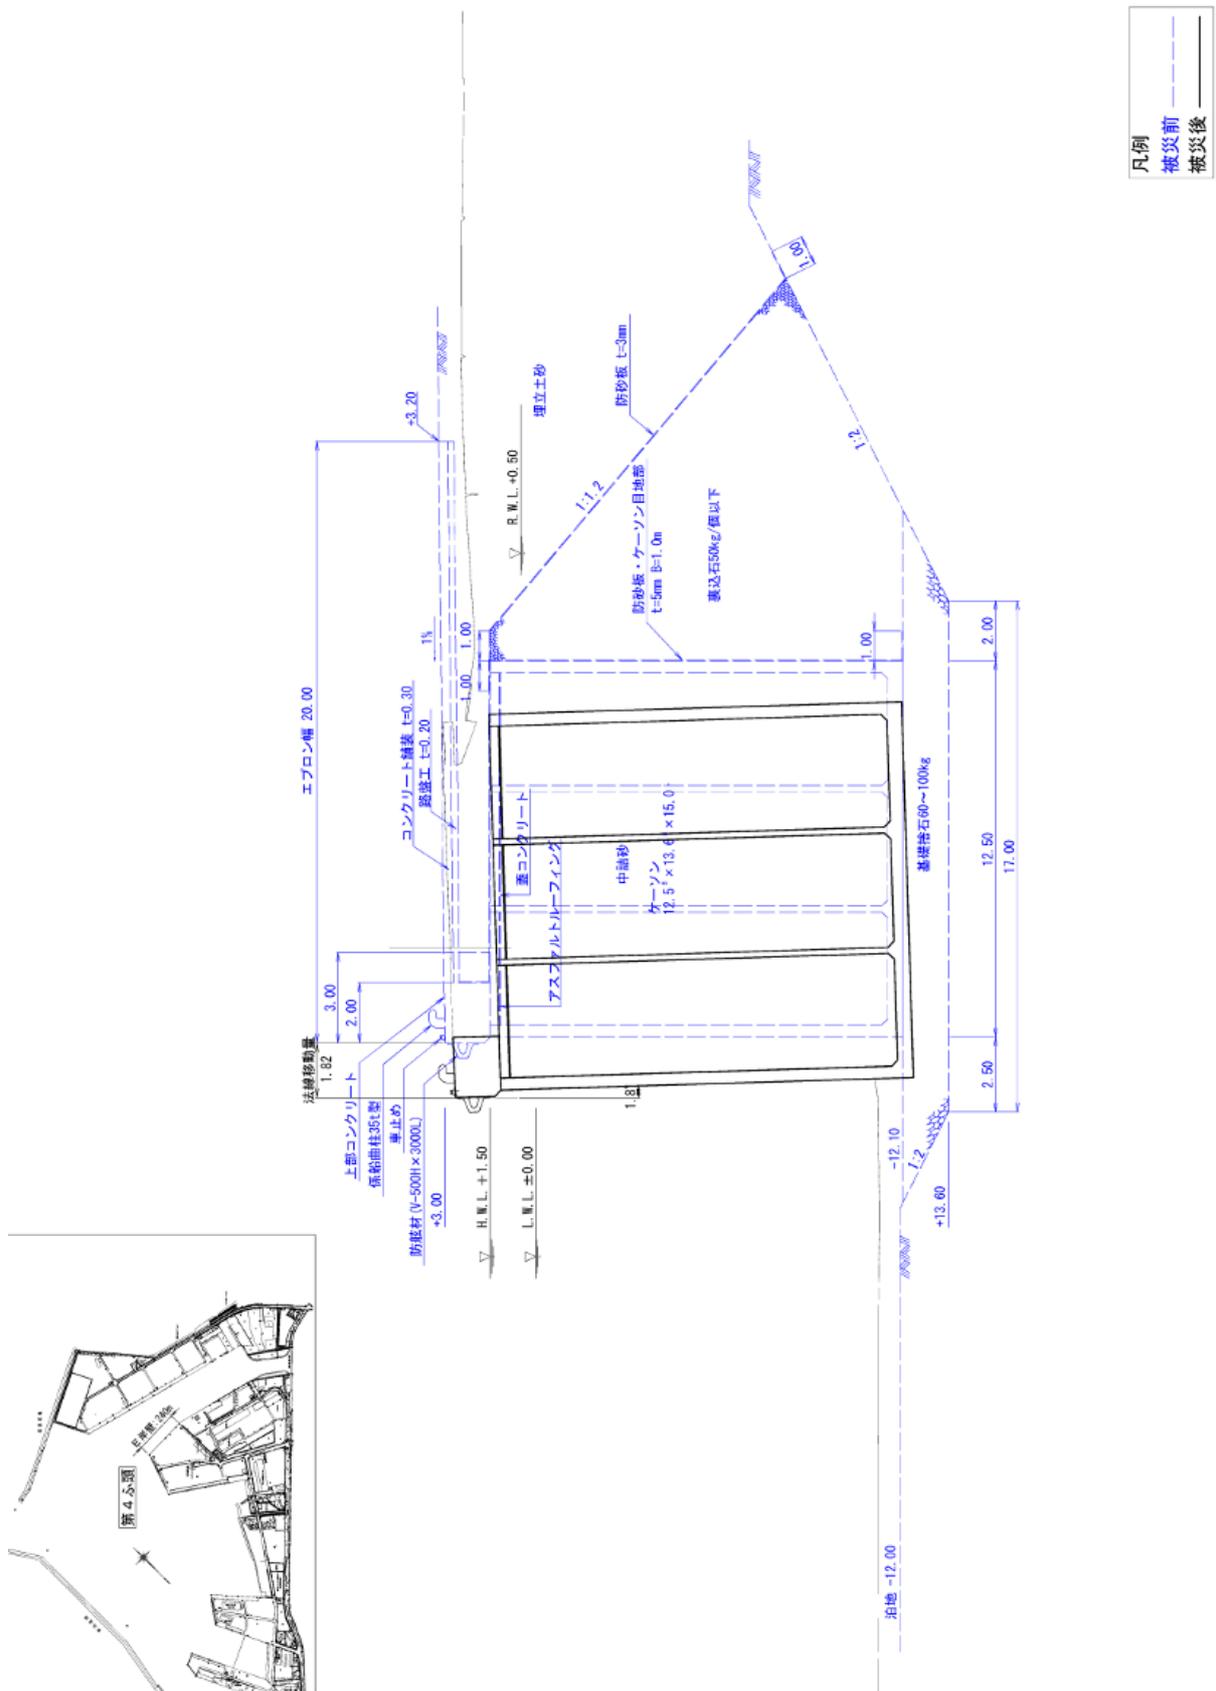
No.11 日立港区_第4ふ頭地区 4-E岸壁 (-12.0m) の断面図 (被災前・後)
